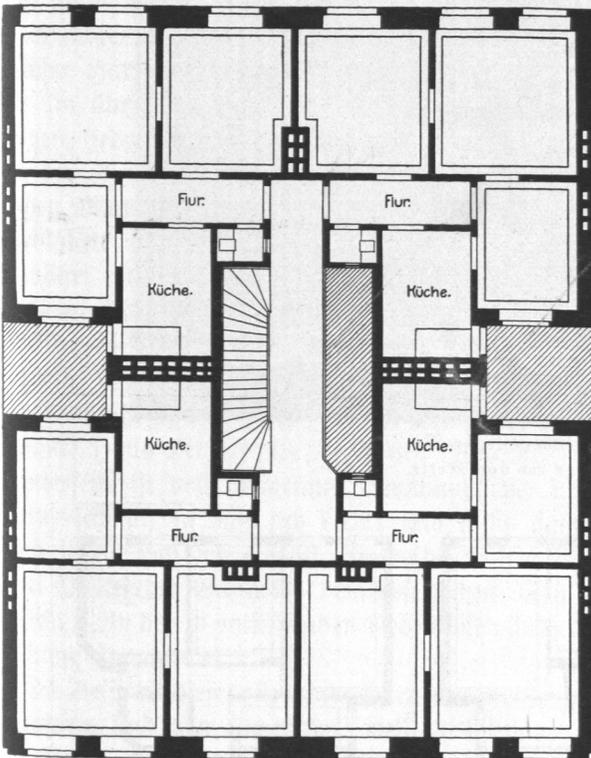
Haus Süderstraße Nr. 6, Obergeschoß.
